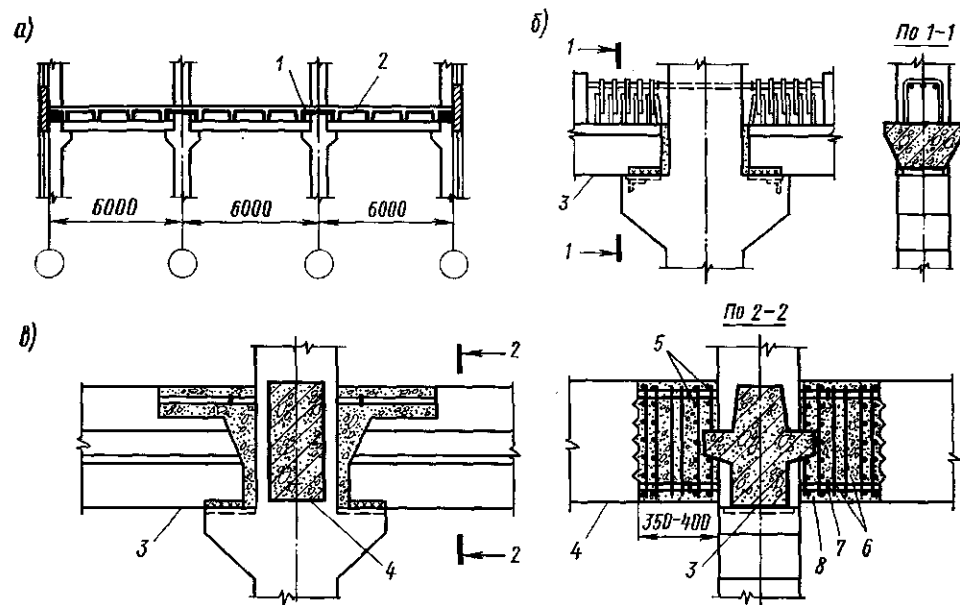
Детали каркасов многоэтажных сейсмостойких зданий:
